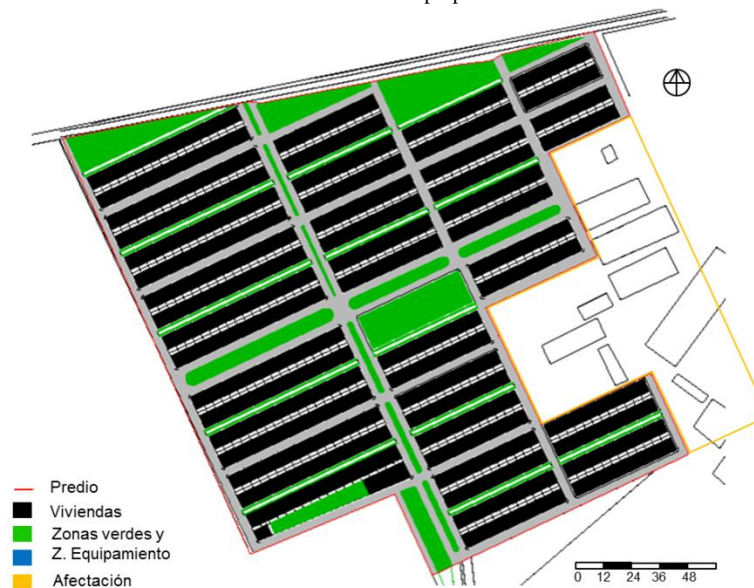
Ubicación en el territorio, Fundación. Autoría Propia.
